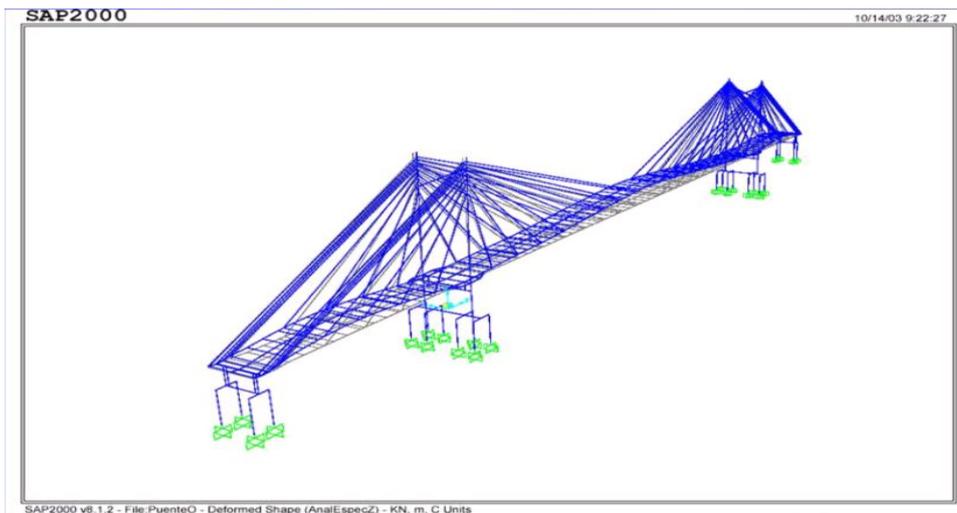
Modelo del Puente Atirantado en el programa SAP 2000
